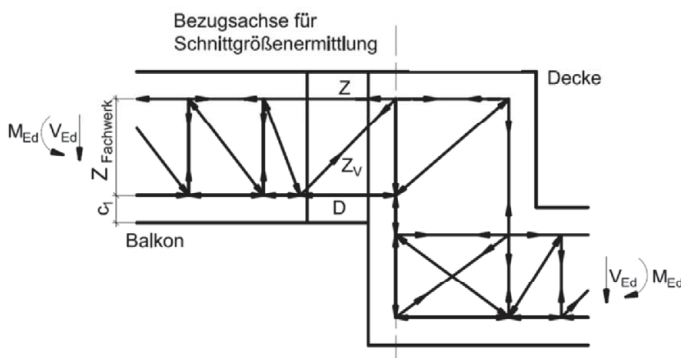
Schöck Isokorb® Typ K-O und K-O-F mit Anschluss an Höhenversatz
